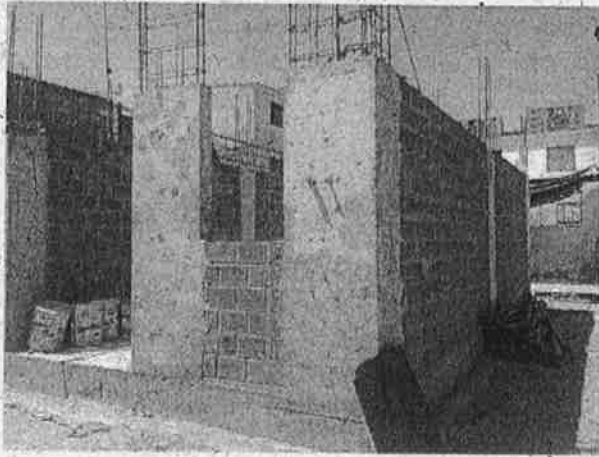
Estado actual de viviendas que fueron resciliadas y que se ubican en calle Av. Los Cóndores, a la espera de reconstrucción de obras.
